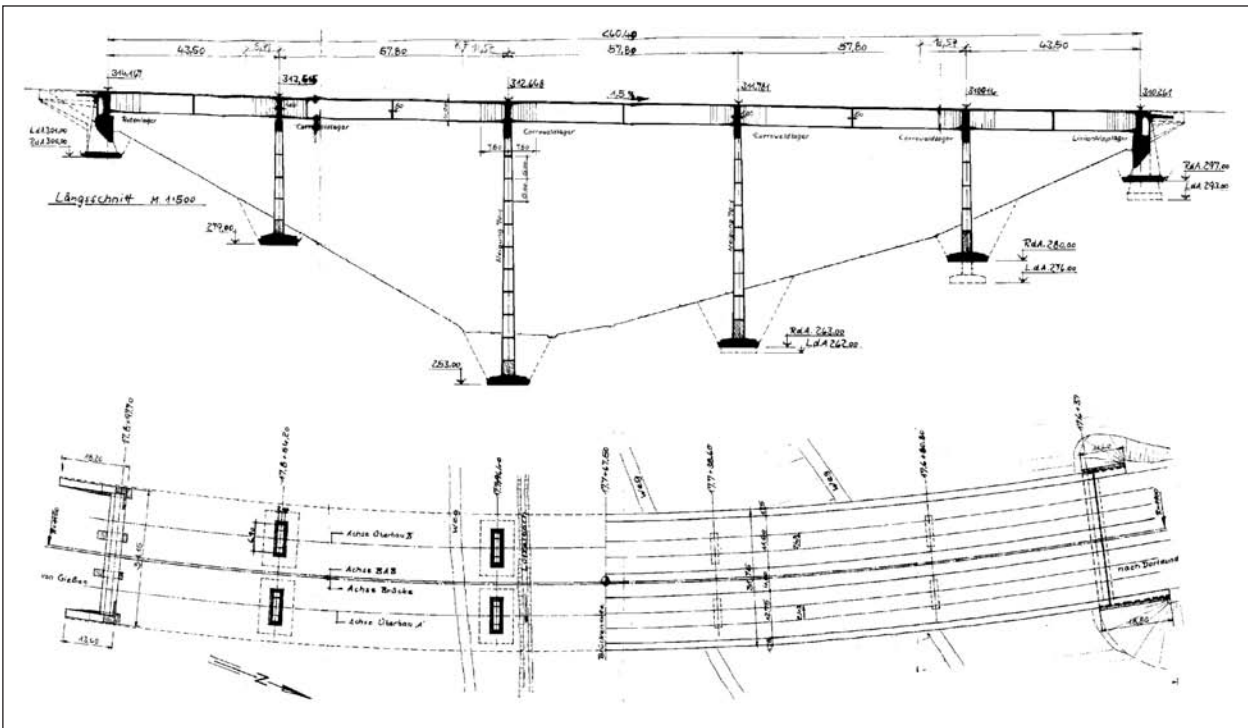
Ansicht und Grundriss der Lützelbachtalbrücke
